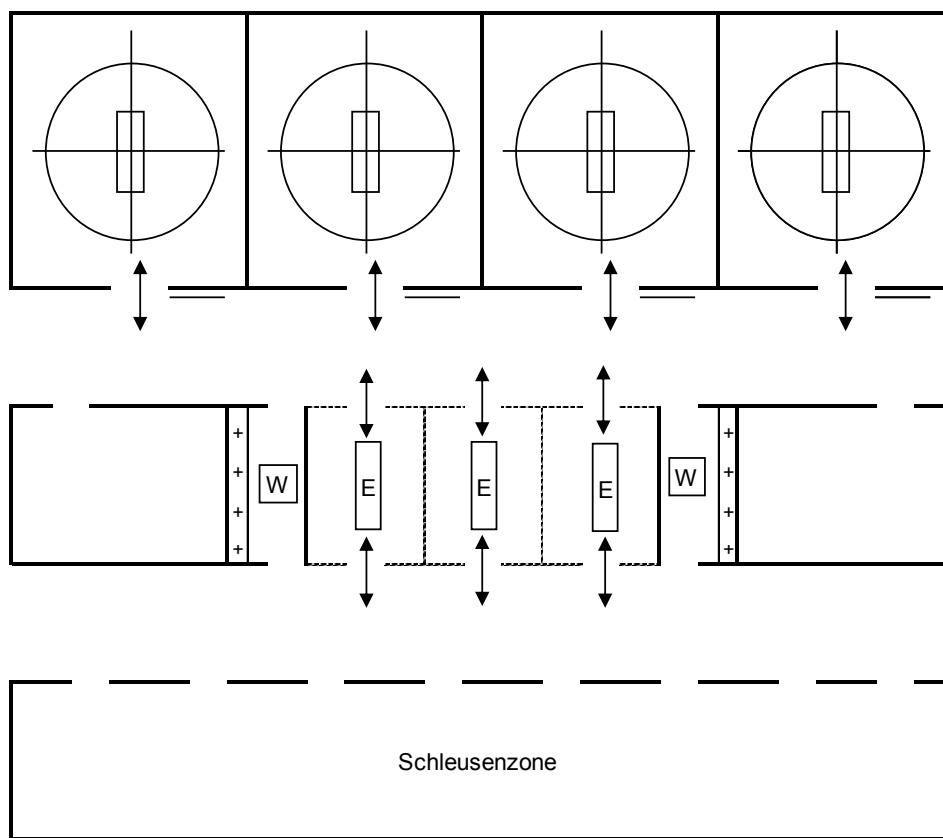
Systemgrundriss Variante für OP-Abteilungen nach RKI 2000, aus ARGEBAU - Arbeitshilfe OP 11/2001
